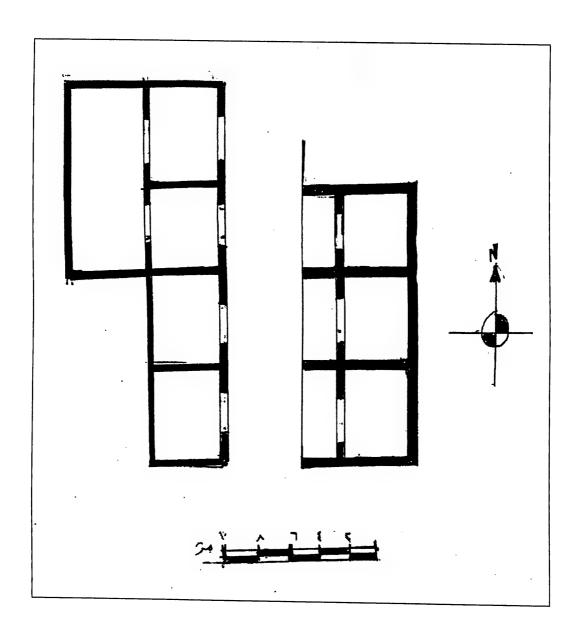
مسقط أفقي لبقايا المبنى السكني (ب) بمدينة الجميرا
